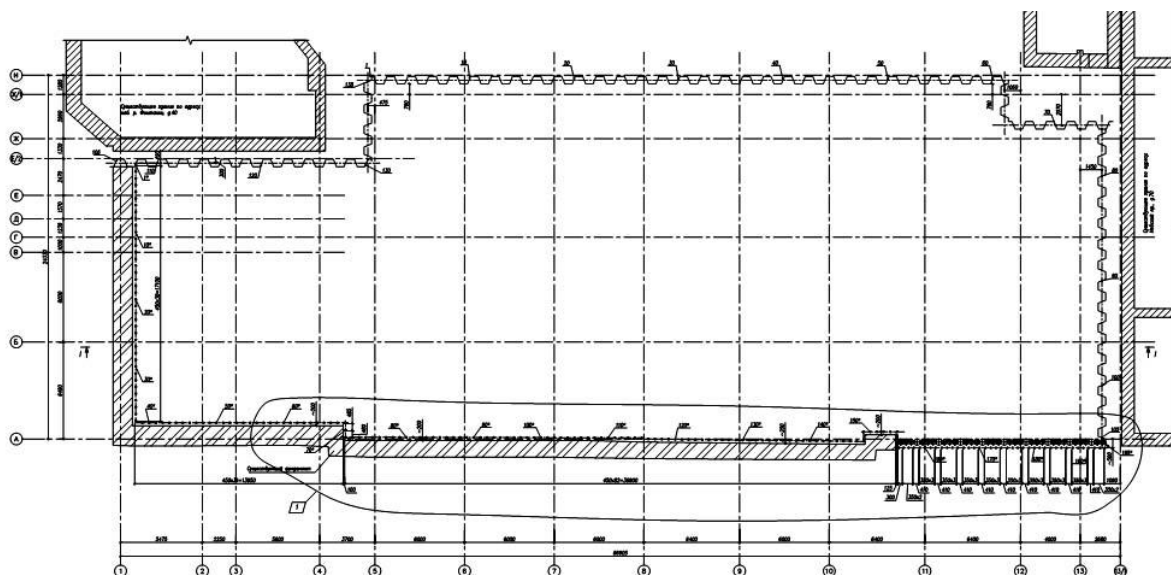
7. План расположения шпунтового ограждения и выполненного Jet-grouting
